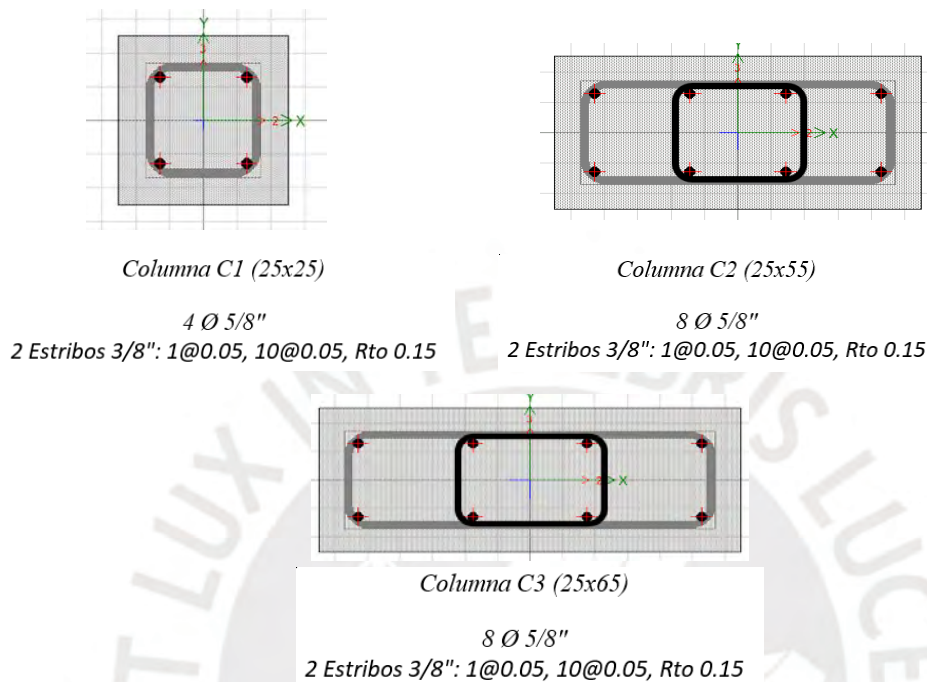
Sección del diseño de acero de las columnas C1, C2 y C3.
